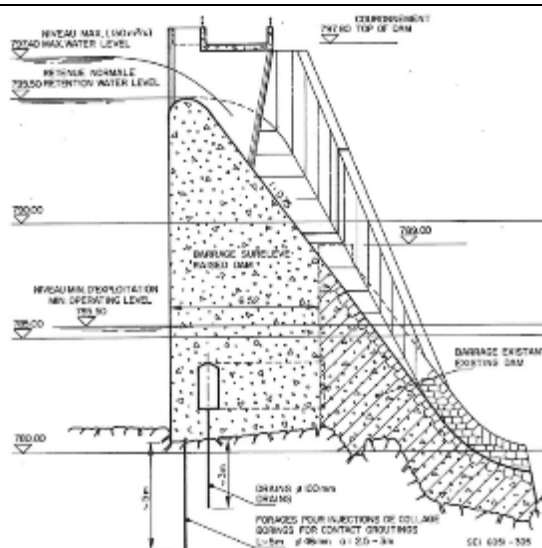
Coupe transversale du Barrage de Käppelistutz, Source: Stamm (1984)
